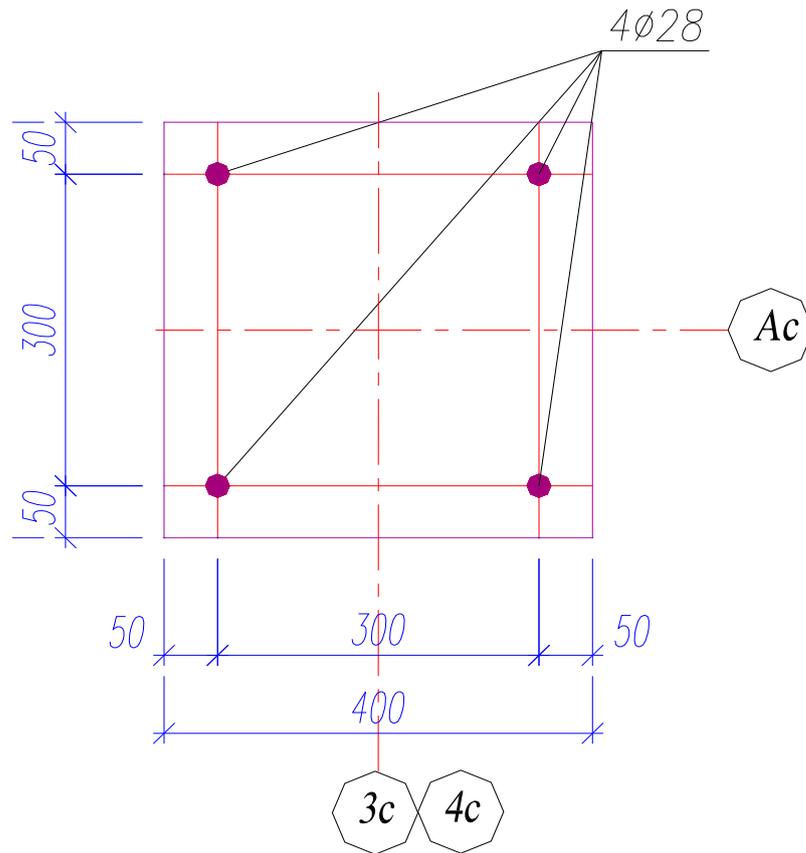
Размещение продольной арматуры в поперечном сечении колонны
